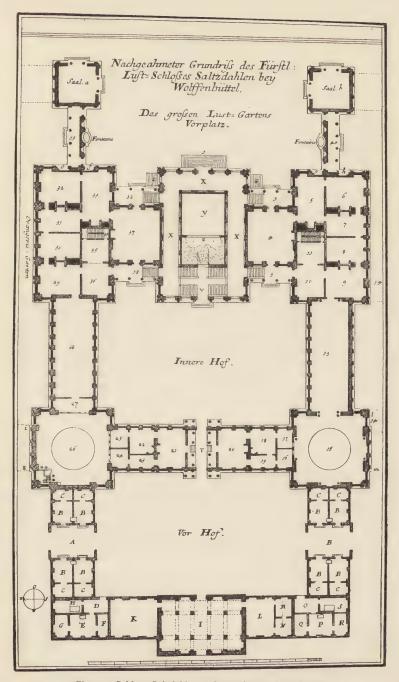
Schloss Salzdahlum. Grundriss, nach L. Sturm.
